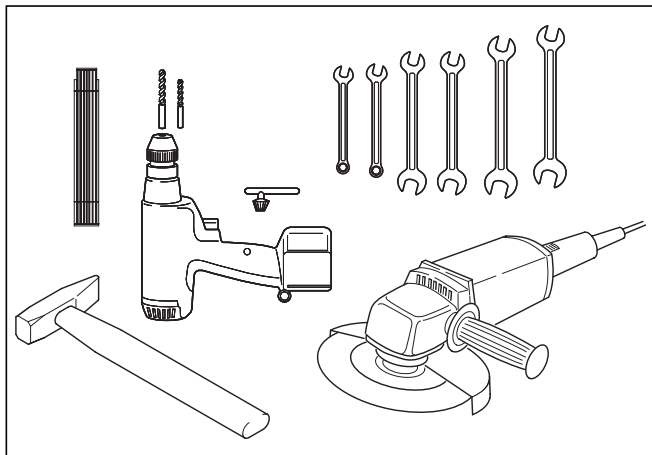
Benötigtes Werkzeug bei Pfannen- oder Ziegeleindeckung
